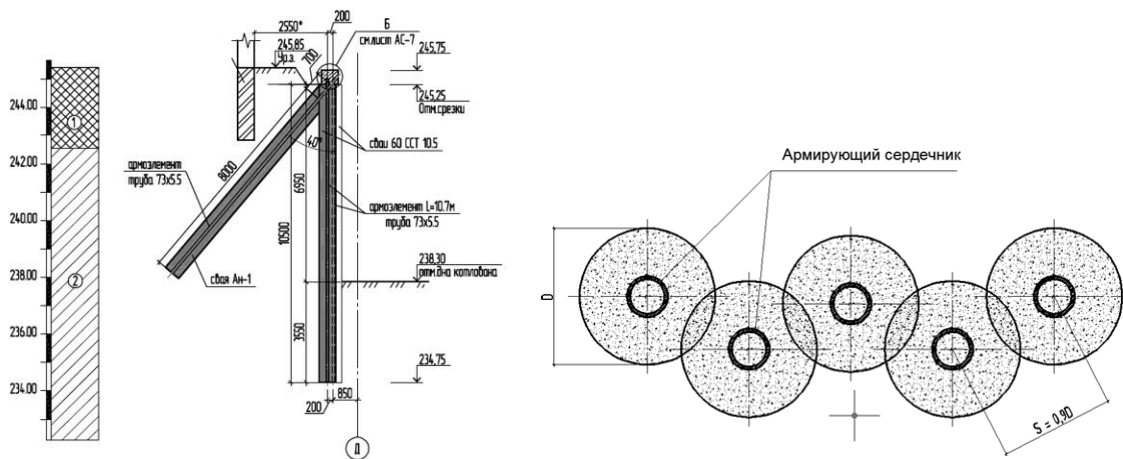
Конструкция и сечение ограждения котлована из грунтобетонных элементов
